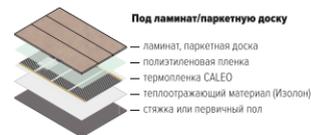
Схема монтажа теплого пола CALEO под ламинат или паркетную доску
